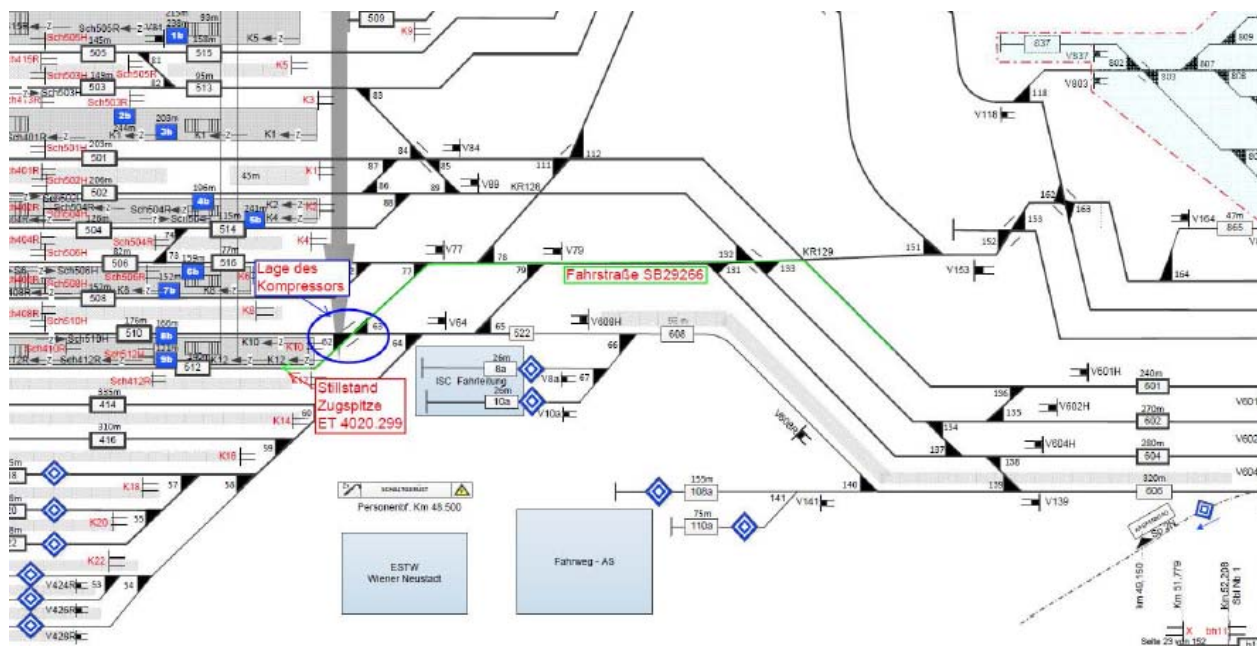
Lageplan Bf Wiener Neustadt Hbf (Quelle IM)
